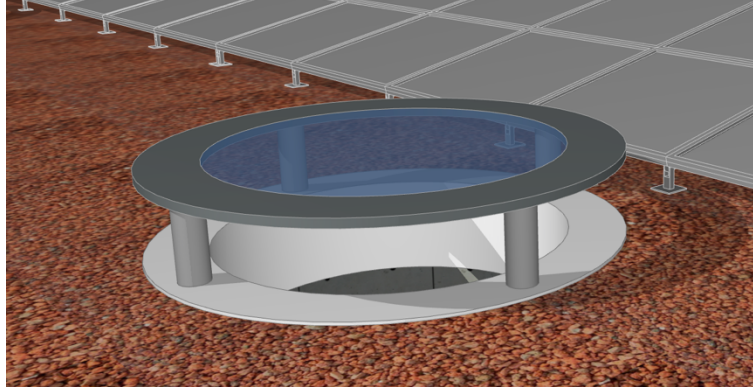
Cubierta ecológica situado en planta de garaje. Lucernario de superficie circular.
